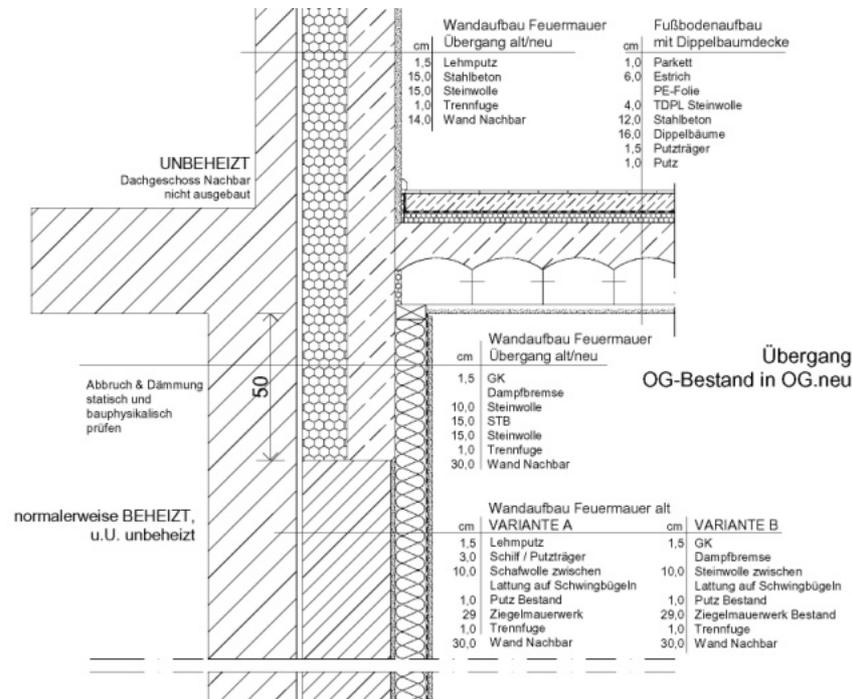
Herstellung einer neuen Feuermauer mit Außenwärmedämmung im Dachgeschoß, Symbolbild²⁵
